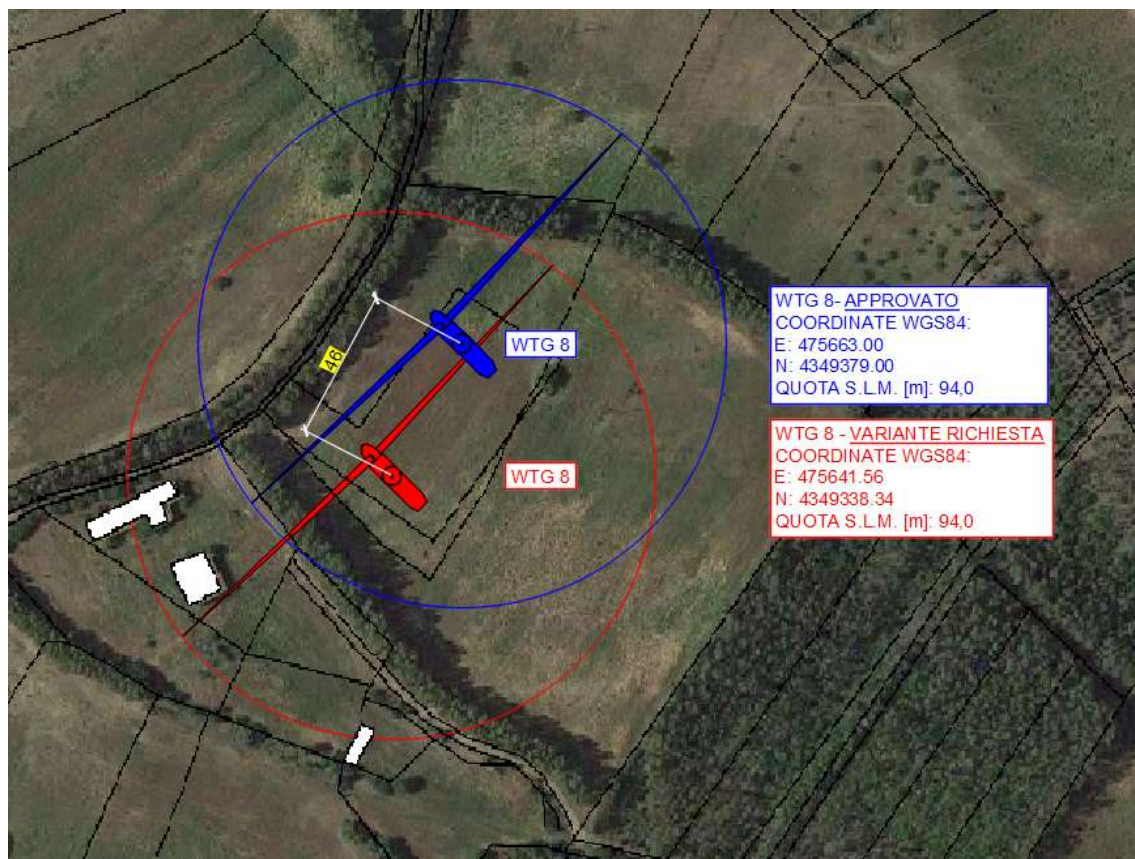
Confronto posizione WTG 8 tra progetto approvato e progetto in variante
